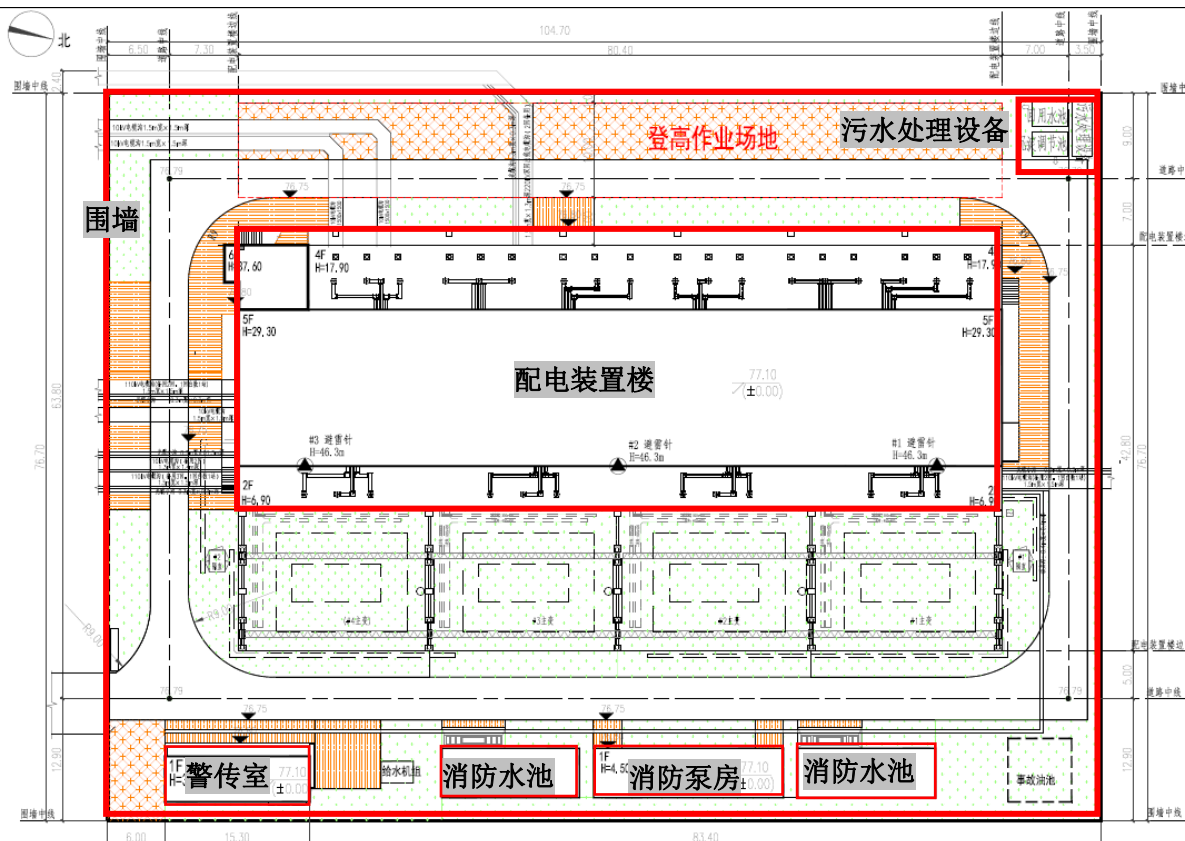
220kV 白土数据中心开关站总平面布置图
